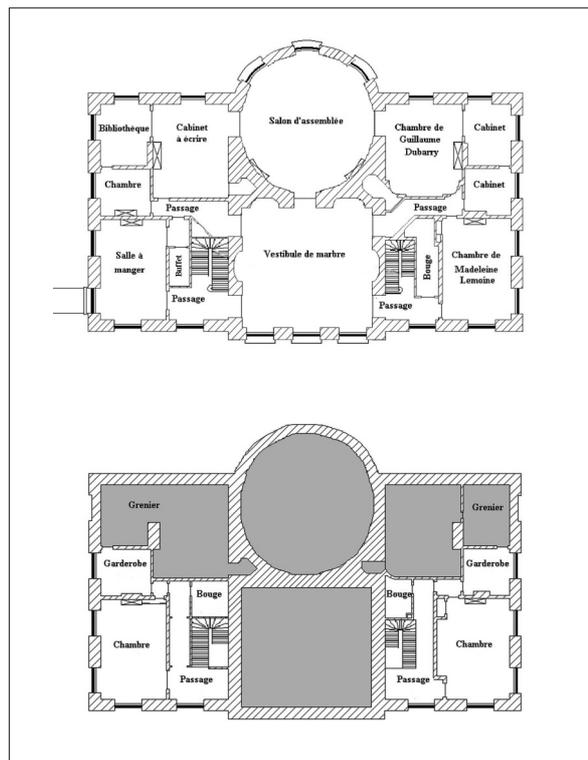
b. PLAN DU CHÂTEAU NEUF DE REYNERIE,
